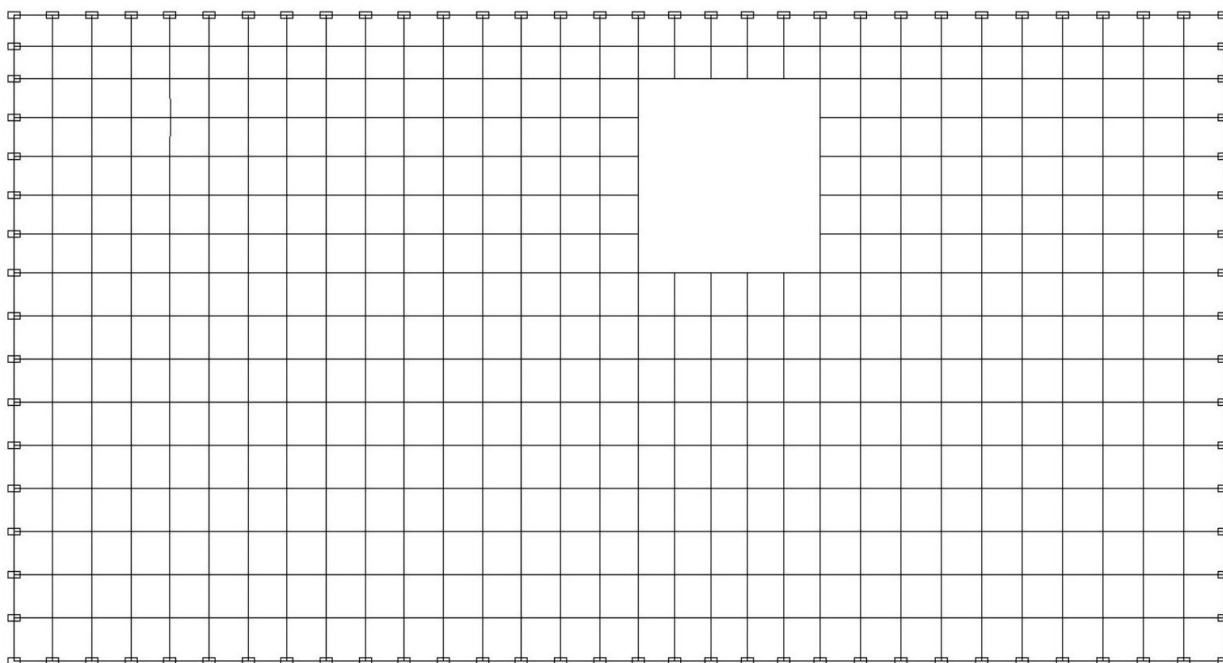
Розрахункова схема плит перекриття та покриття
